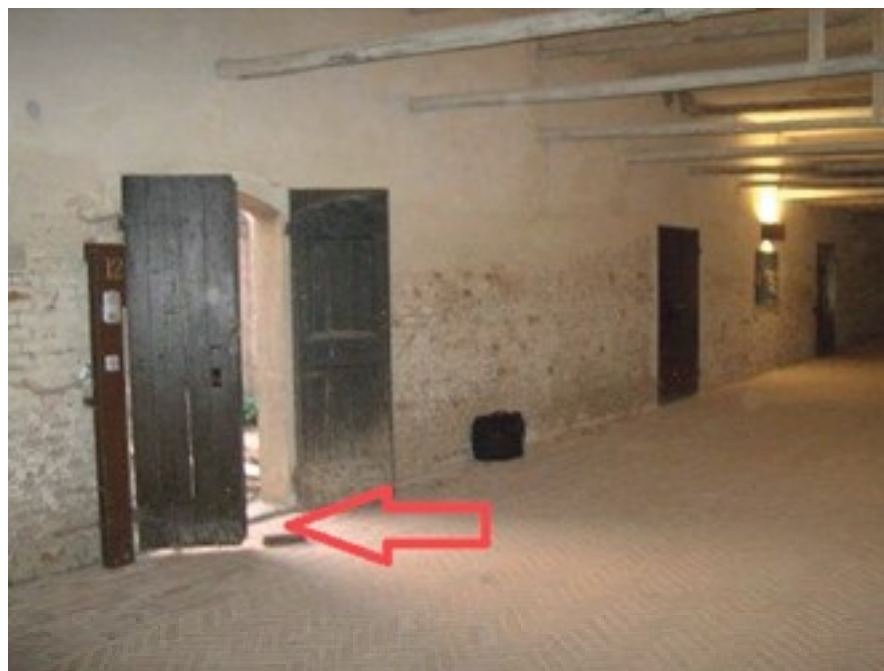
porta di accesso all'u.i. Sub.4 -lotto n.1 -
